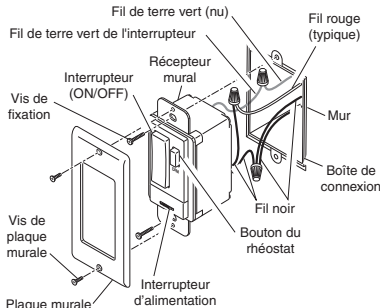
Installation d'un interrupteur mural tripolaire (transmetteur illustré)
